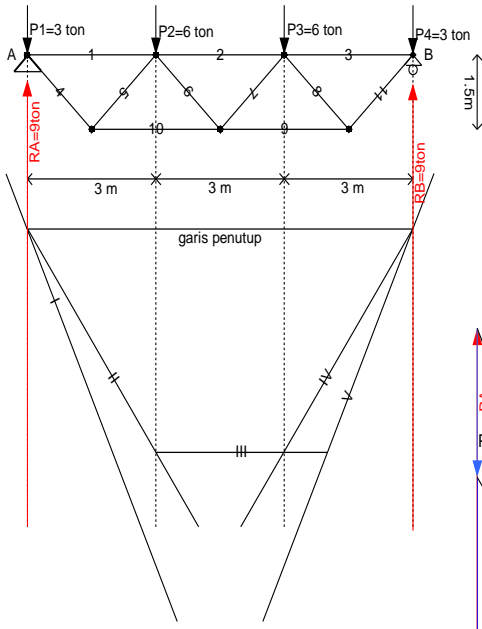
Konstruksi rangka batang simetris, mendapat beban-beban simetris
